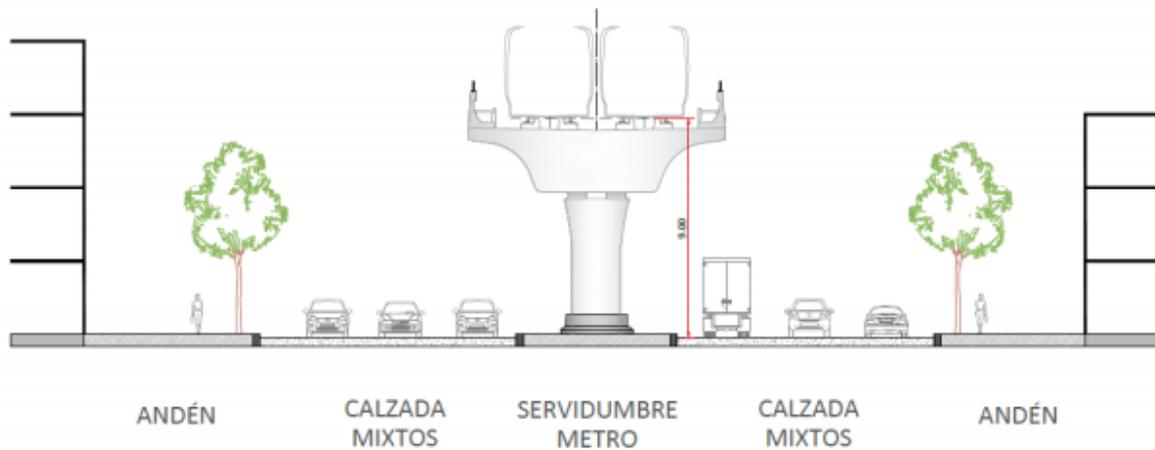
Sección tipo Av. Villavicencio con inserción central sobre separador existente – Fuente: SYSTRA
